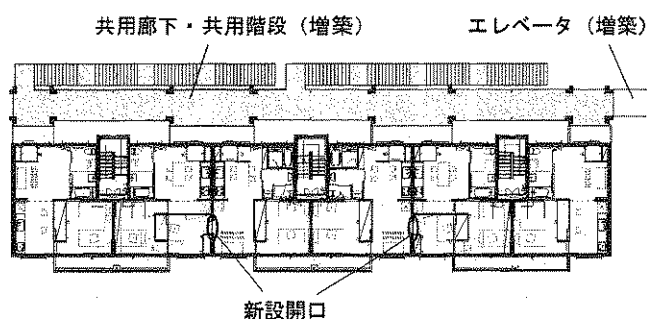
WPC 構造住宅の大規模改修モデル計画の一般階平面図
